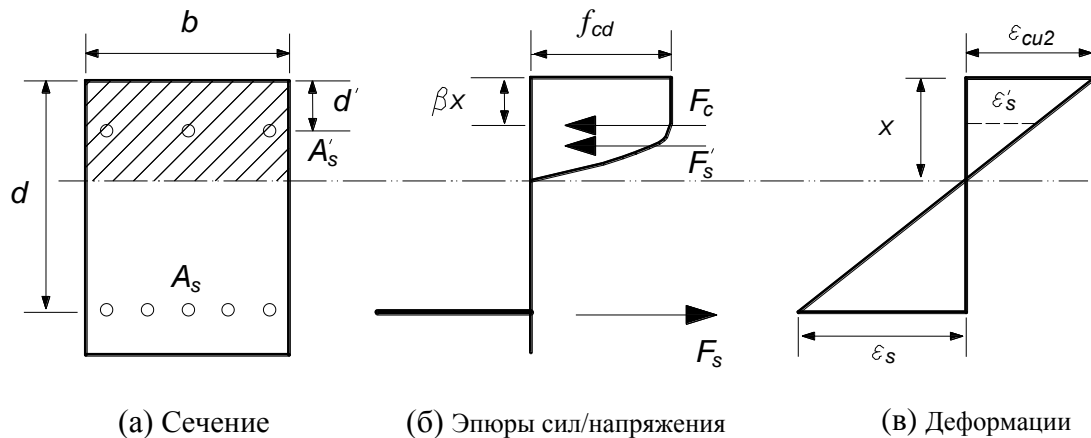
Балка прямоугольного сечения с двойным армированием при разрушении (параболически-прямоугольная эпюра напряжения)
